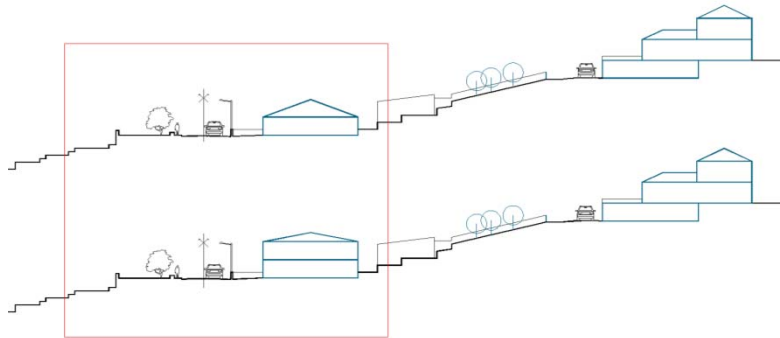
Ensaio no perfil longitudinal de um troço da ER na zona consolidada
